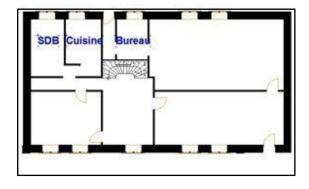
Plan de masse de la ferme pilote actuel. (Source : auteurs)
